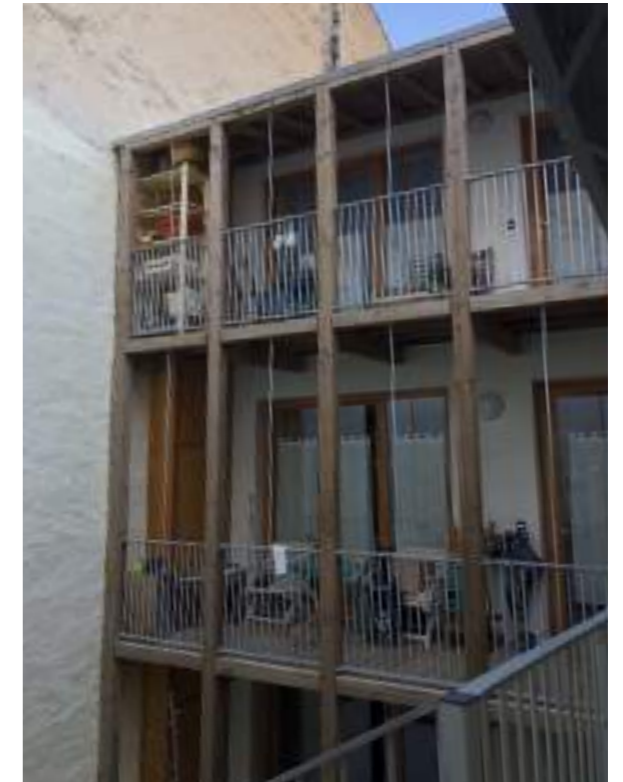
Photographie de la façade retrouvée de l'immeuble Gambetta et sa cour
